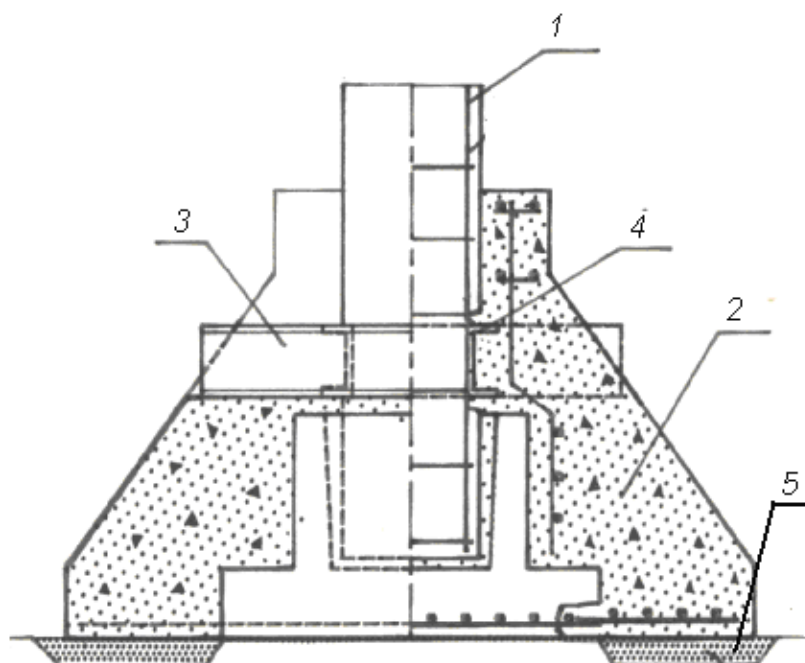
Уширение подошвы столбчатого фундамента с применением поперечных балок: 1 – арматура колонны; 2 – элементы уширения; 3 – опорные балки из швеллеров; 4 – коротыши; 5 – подготовка
